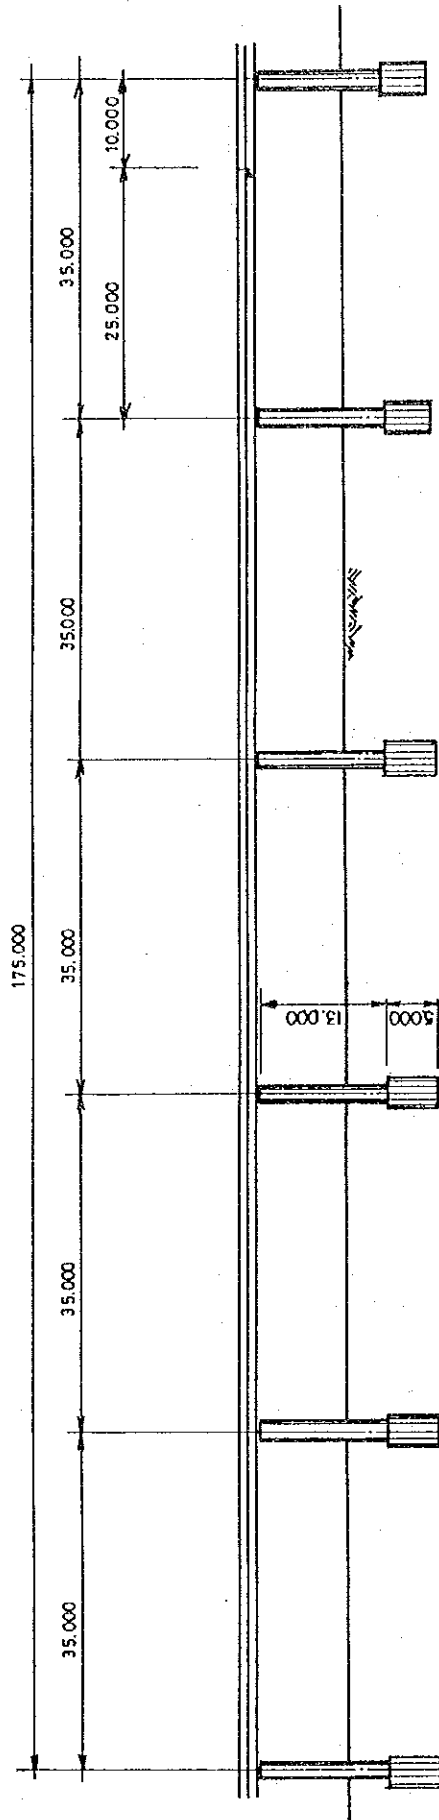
Perfil Longitudinal de Tramos con Vigas Continuas
